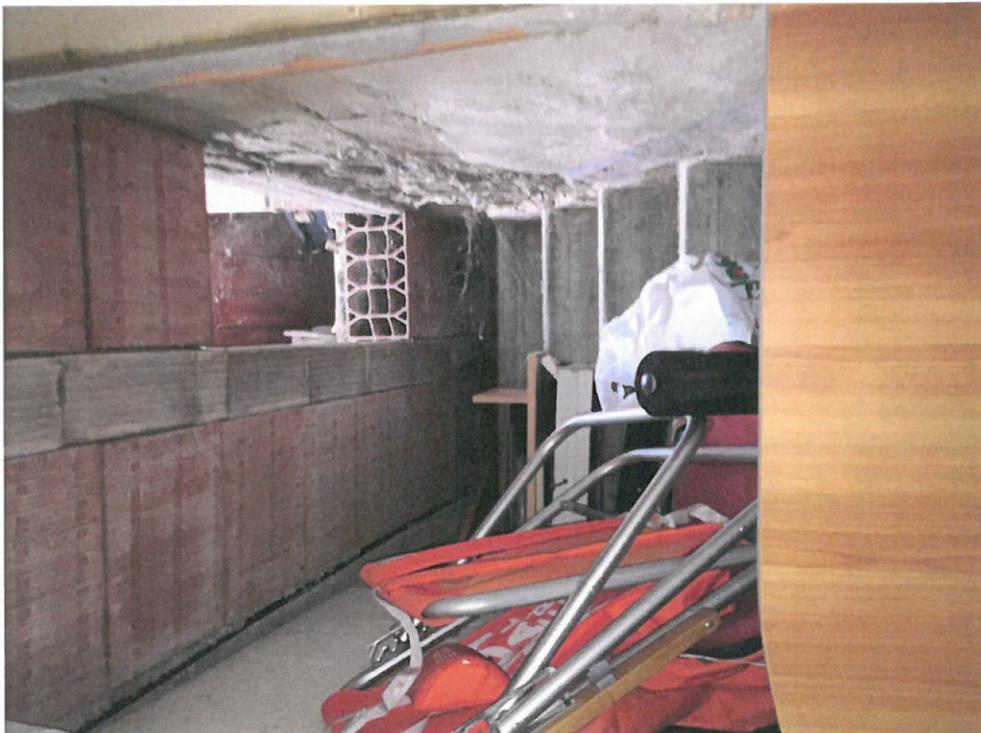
Ingresso dal w.c. piano primo per il piano soffitta.
